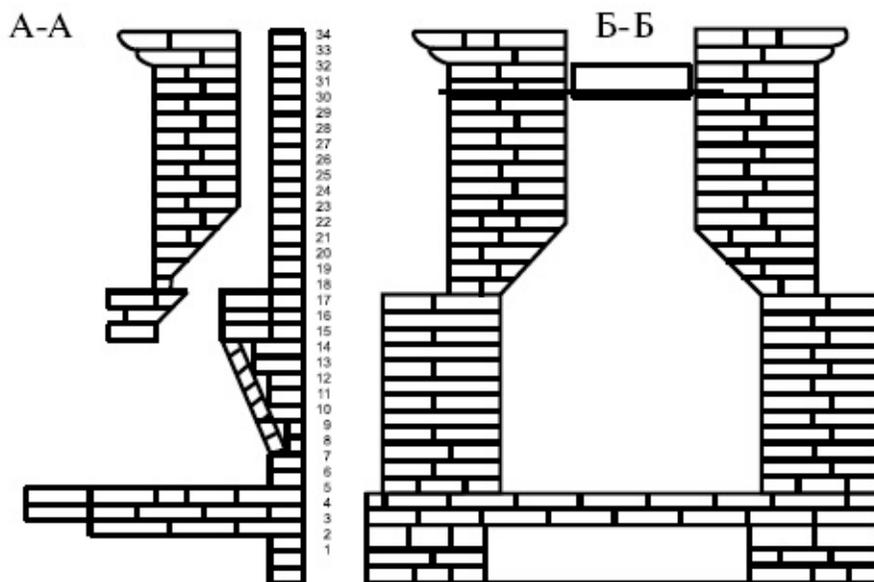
Камин № 3 в разрезах А-А, Б-Б. На 9-м ряду перекрывают духовку № 1 и поверх нее выкладывают опускной дымовой канал
